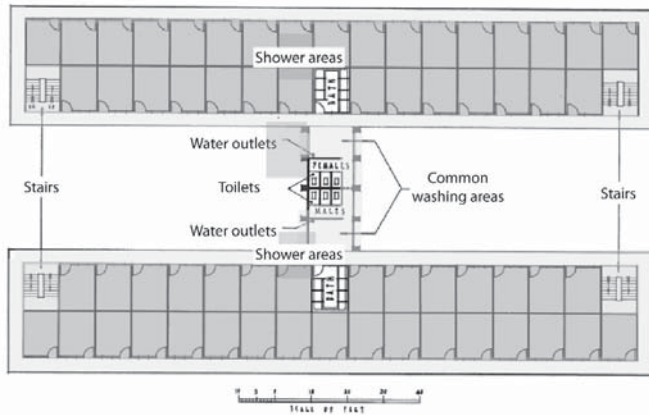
Grundriss eines historischen sozialen Wohnbaus des „Mark I“ - Typs
